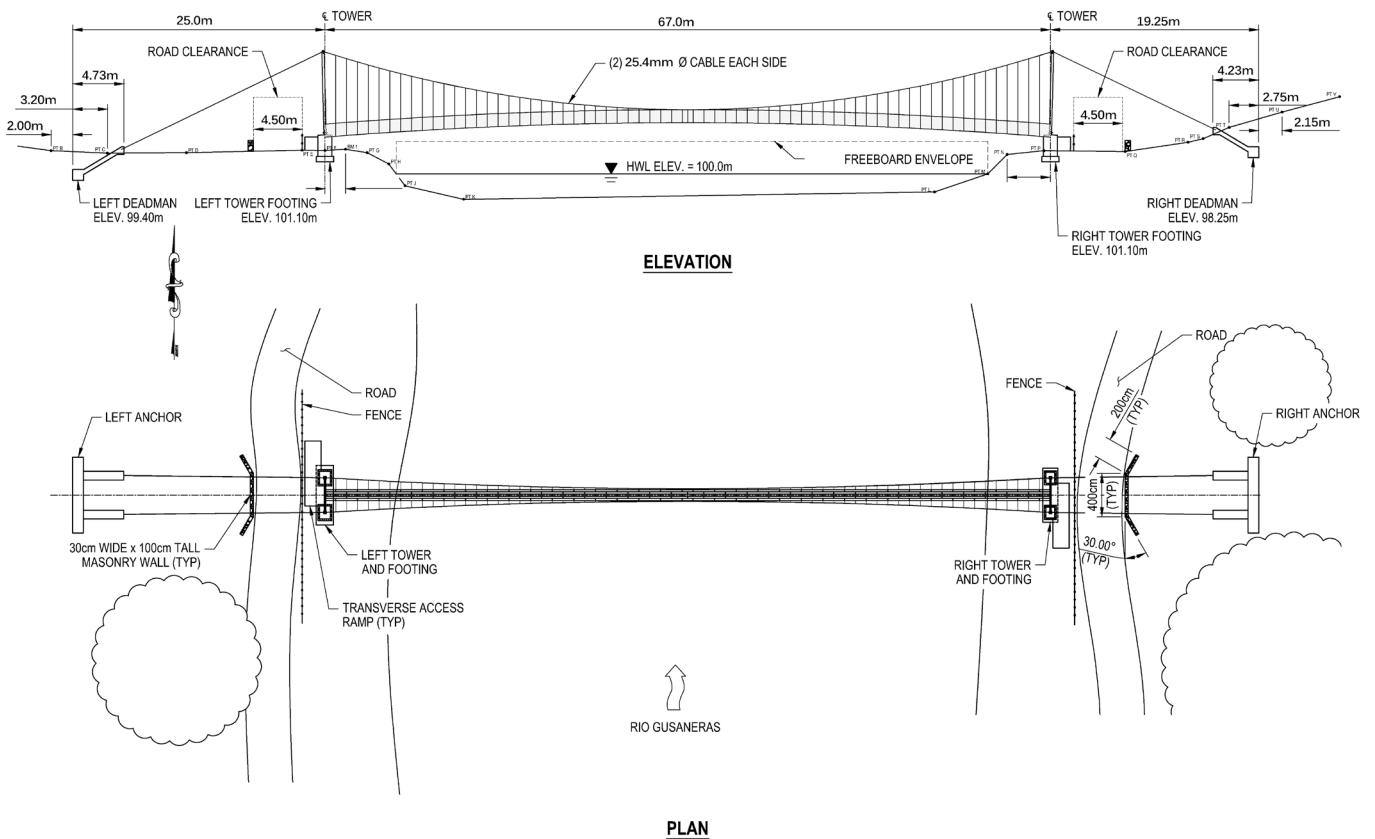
Alzado y planta general de la Pasarela San Vicente.
